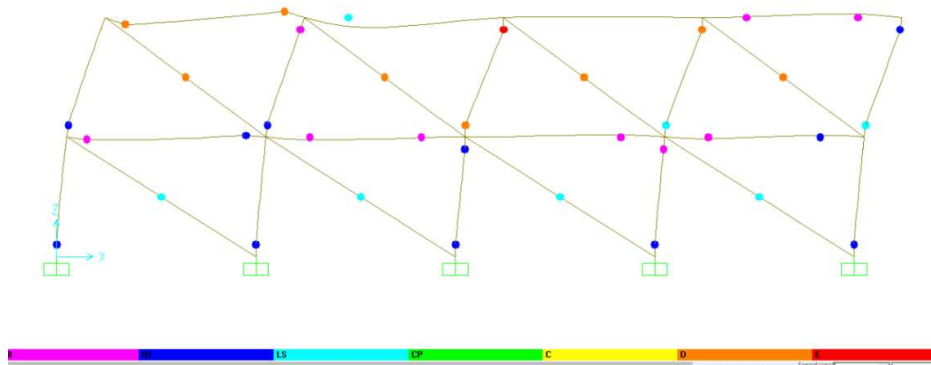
Mecanismo de falla en pórtico de hormigón armado del modelo 4-B.
